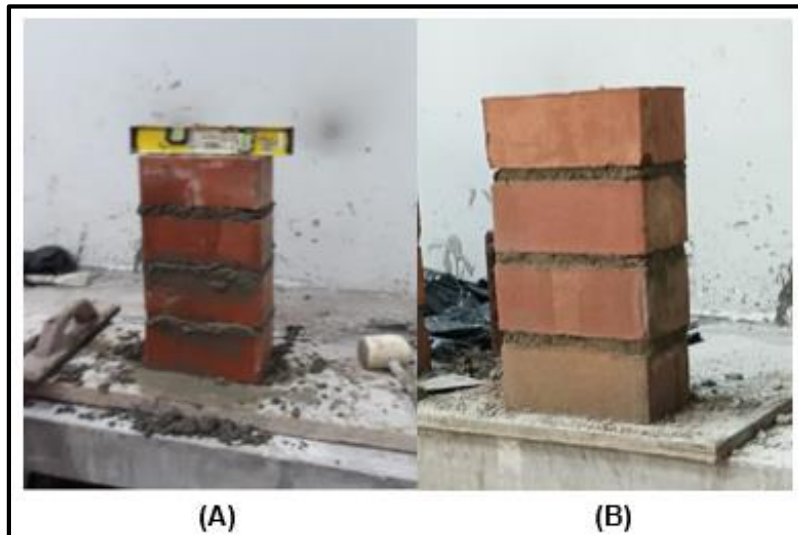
Elaboración de las pilas de albañilería con 4 unidades y niveladas con nivel de mano.
